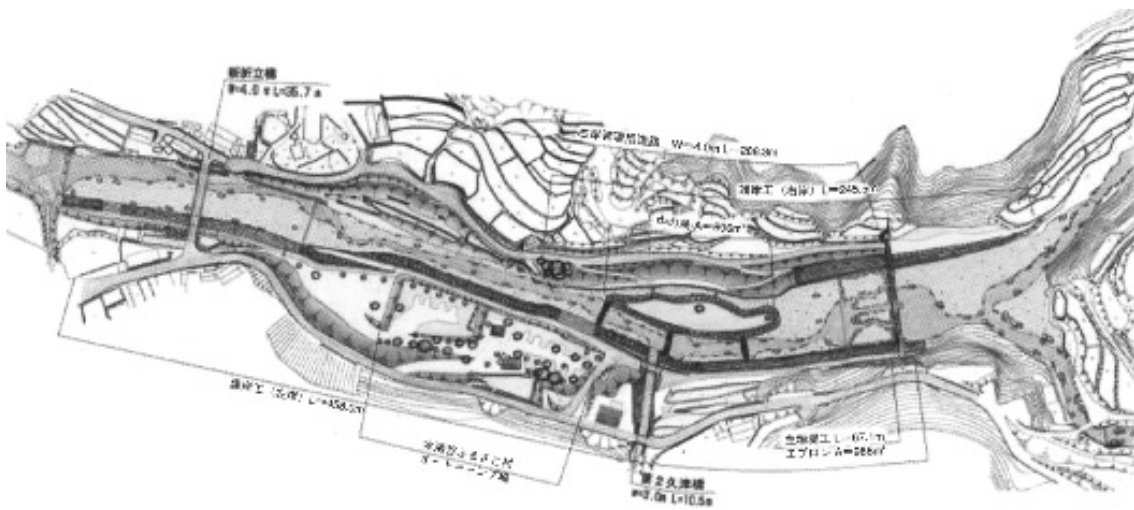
미즈시다니가와 고향사방사업의 계획평면도
